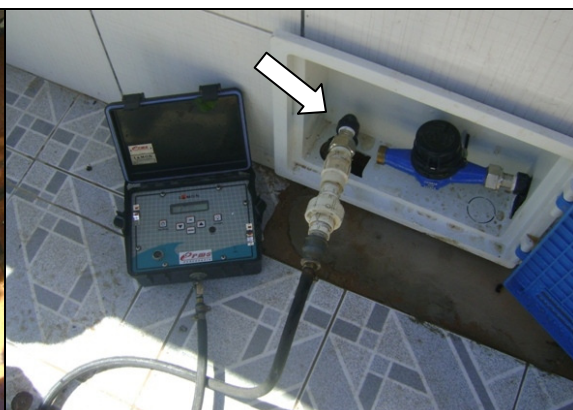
Medição de pressão sem hidrômetro, na Travessa Paula Ney, 73 - Aterro.
